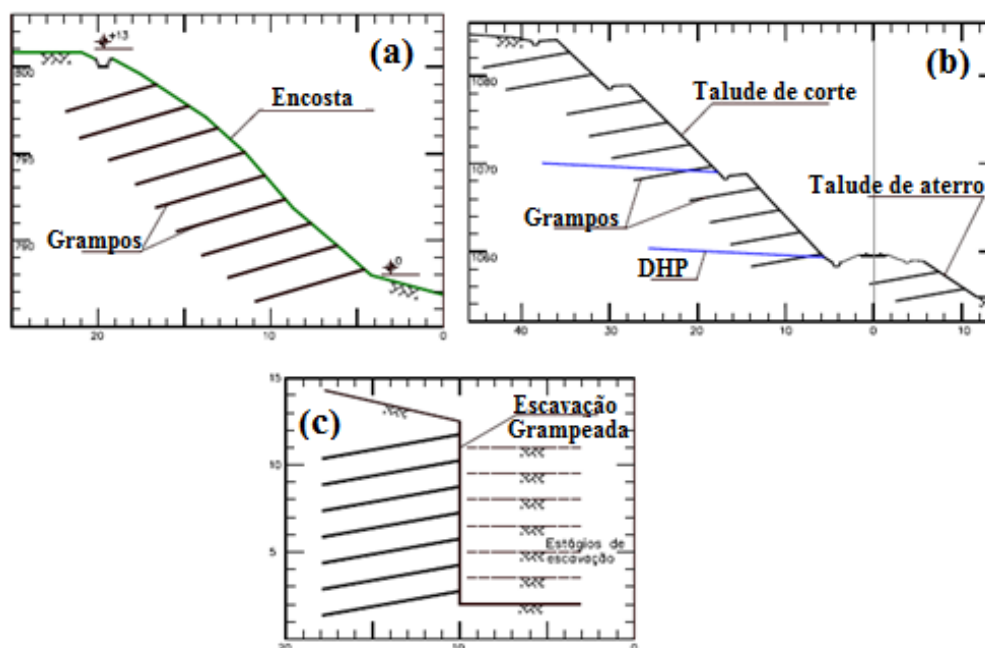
Aplicação de solo grampeado para estabilização de: (a) encostas; (b) taludes pré-existentes de corte e aterro e; (c) escavações (SILVA, 2010)
